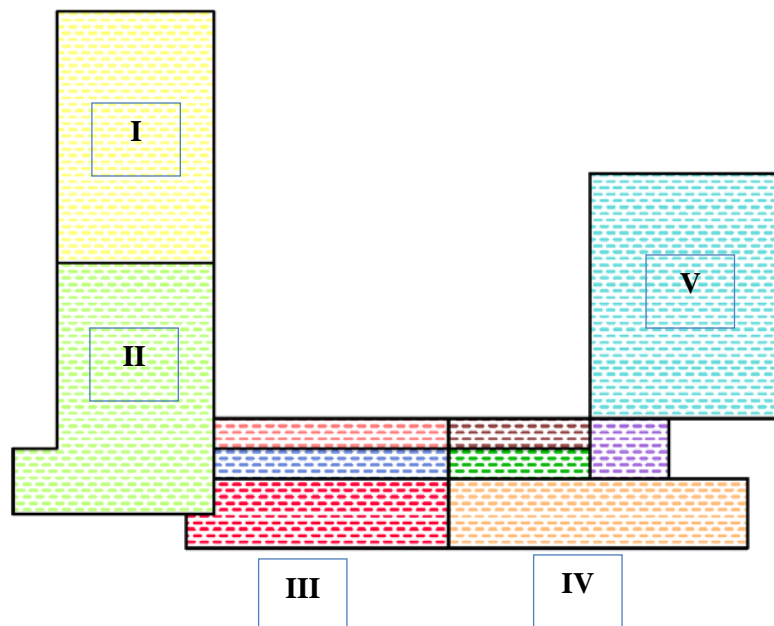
Distribució en planta dels edifici de l'ETSAB al 1954
